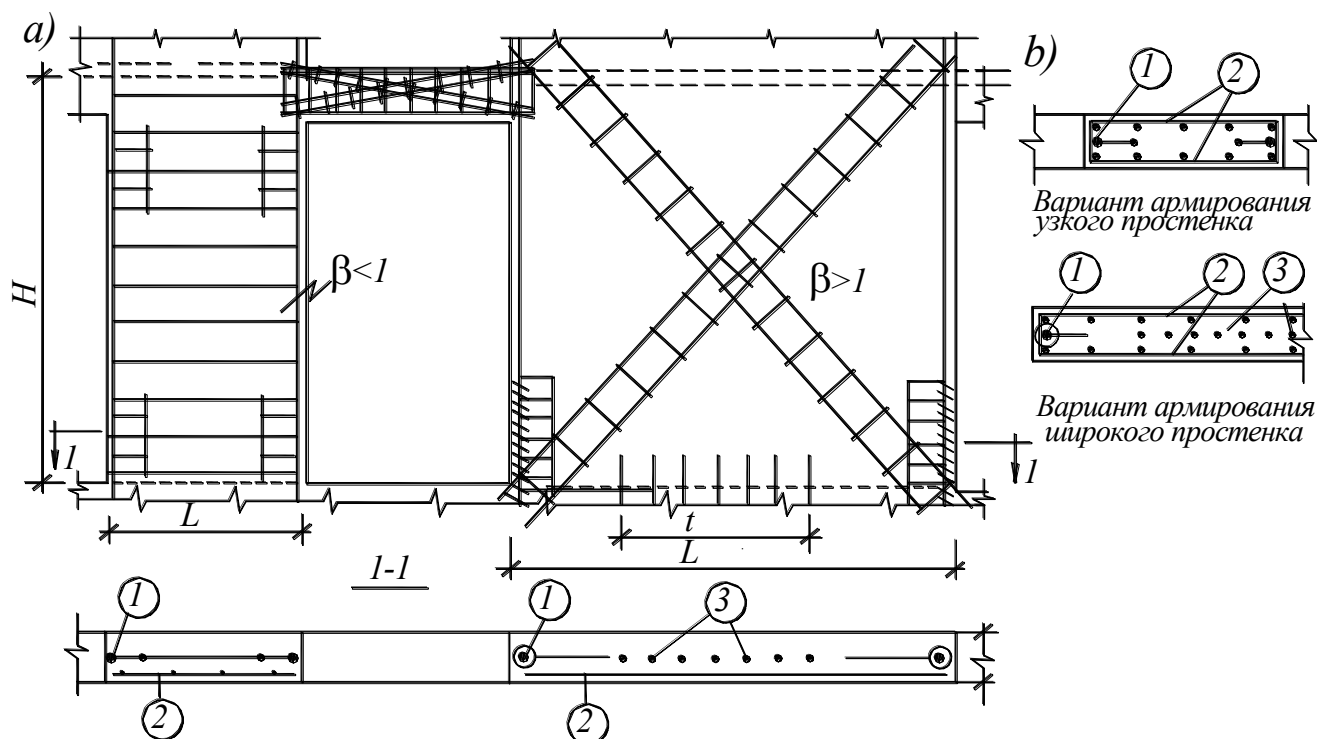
Предлагаемая схема армирования монолитных стен.
